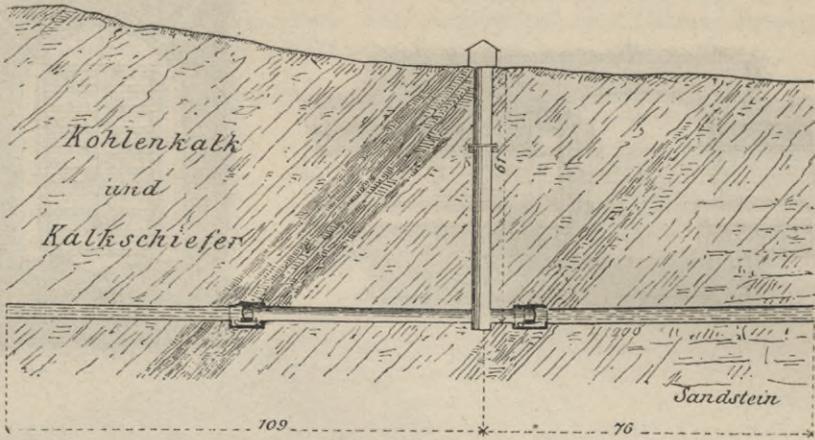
Dammtür im Wiesbadener Sammelstollen. M. 1:80.
